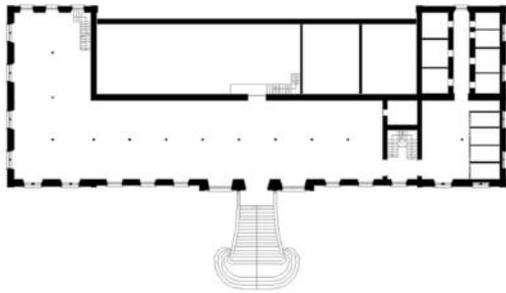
Planta primera. Edificio original / Edificio Rehabilitado.
